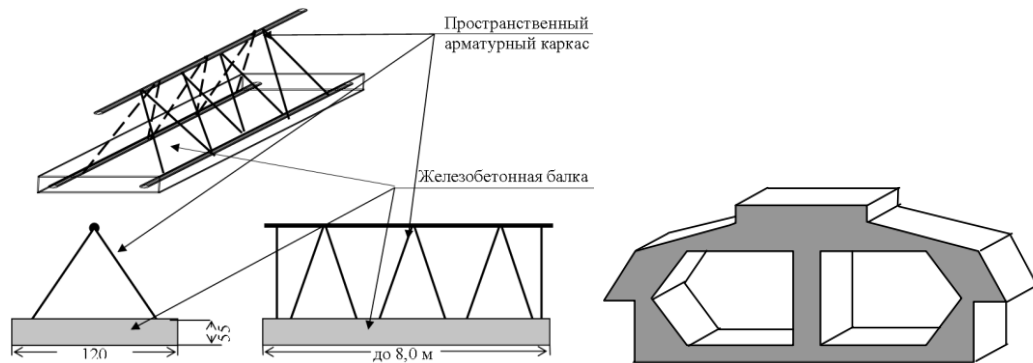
Монтажный железобетонный прогон та керамзитобетонный пустотный блок збірно-монолітного перекриття «ALBERT»
